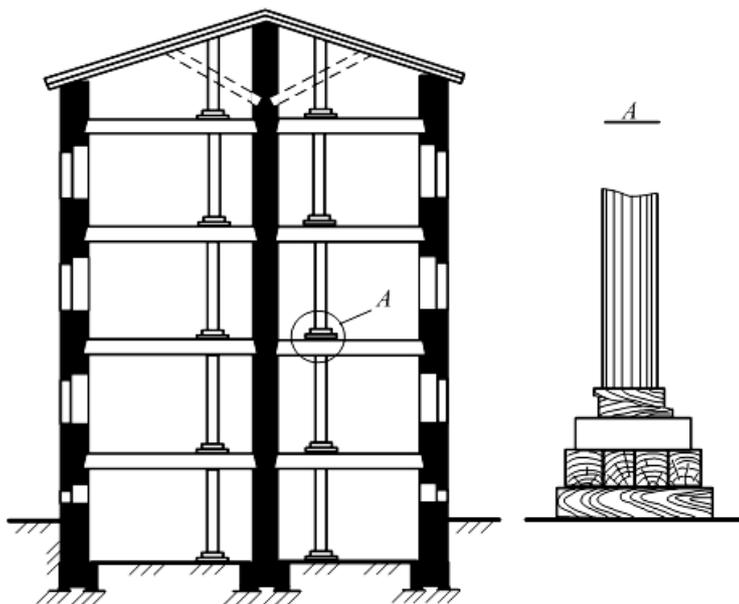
Перекладка средней стены с установкой временных креплений
